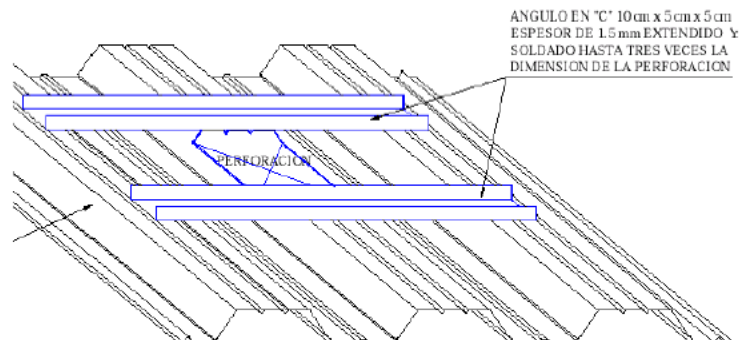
Colocación de perfiles para reforzar la lámina colaborante cuando se hacen las perforaciones
